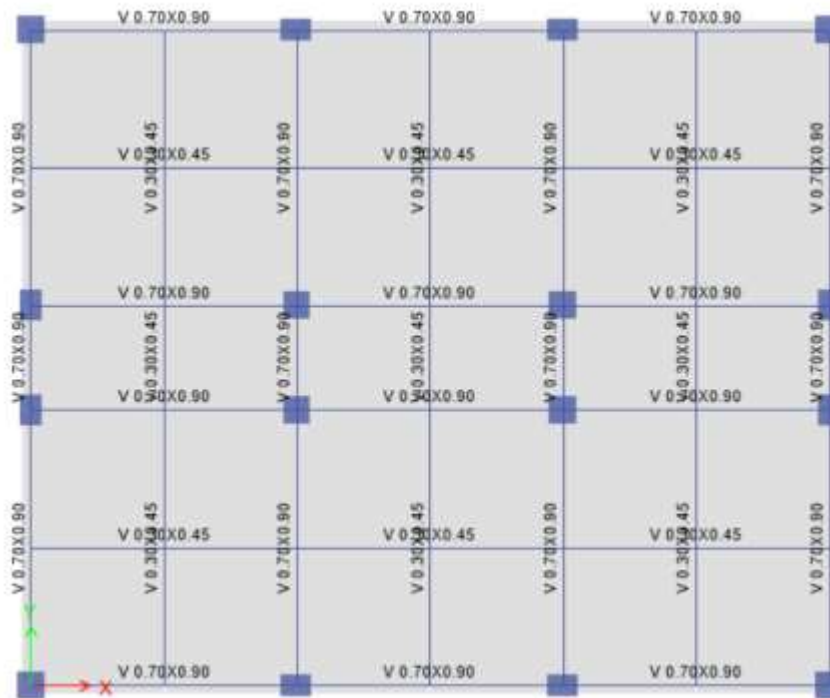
PLANTA DE ENTREPISO TIPICA
